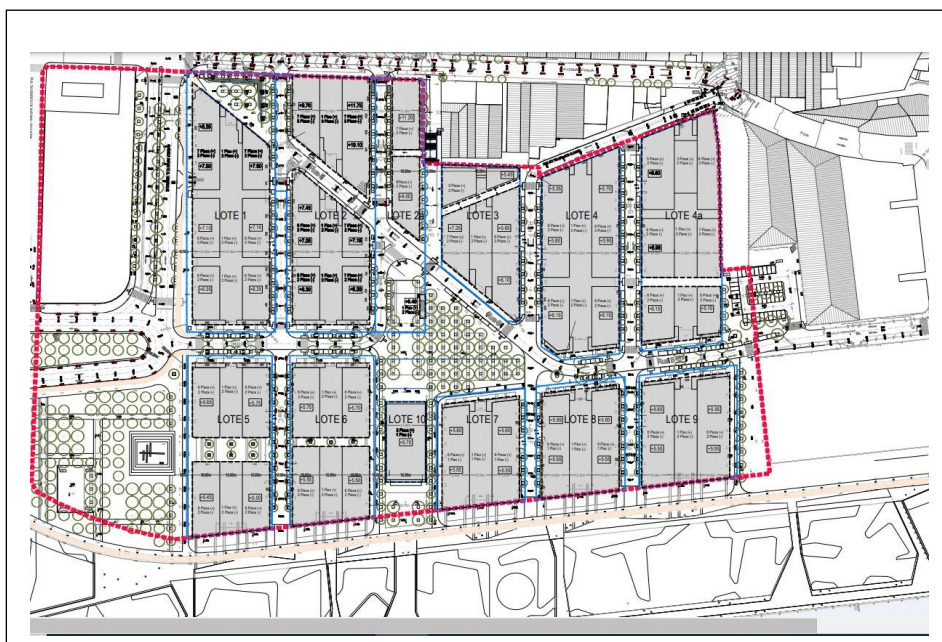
Extrato peça desenhada refª UR-0397-03-00 - Planta síntese, setembro 2021 (3ª alteração loteamento).
